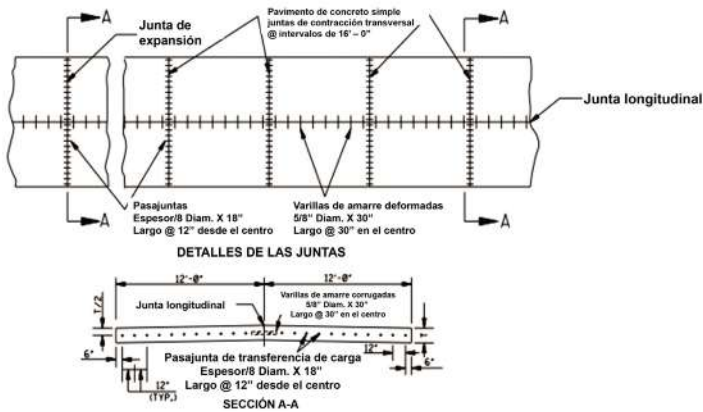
Una vista de planta del pavimento con juntas transversales de contracción y un detalle seccional de la junta trasnversal.
